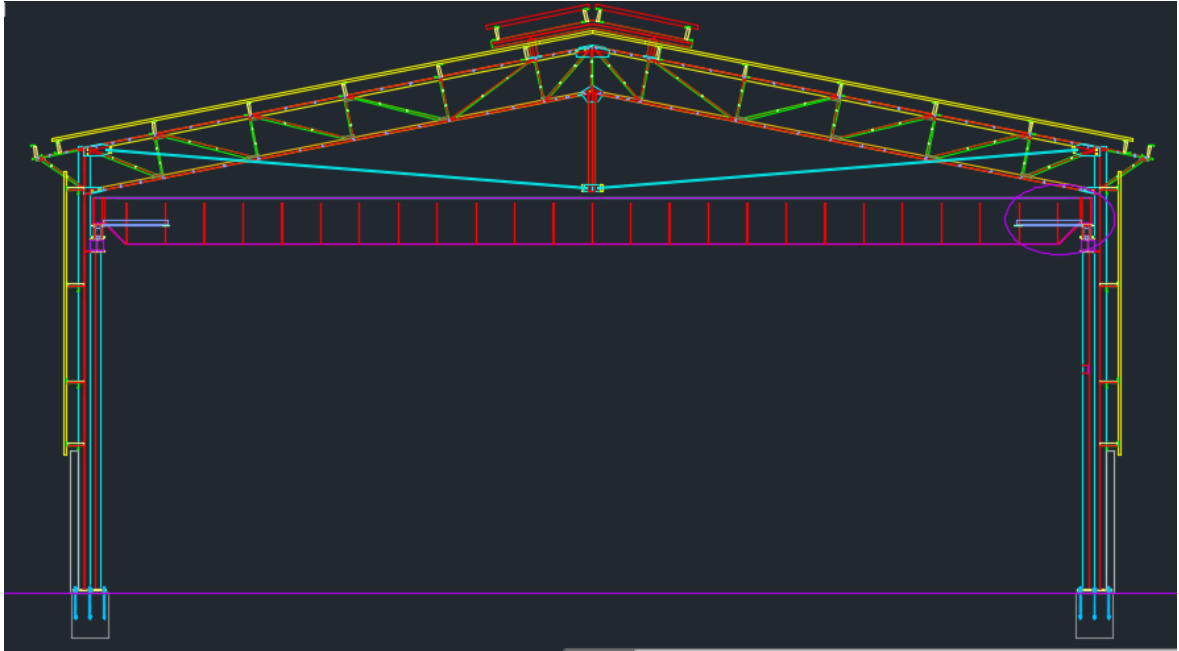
Imagen del Puente- Grúa. Fuente: Planos de la bodega
